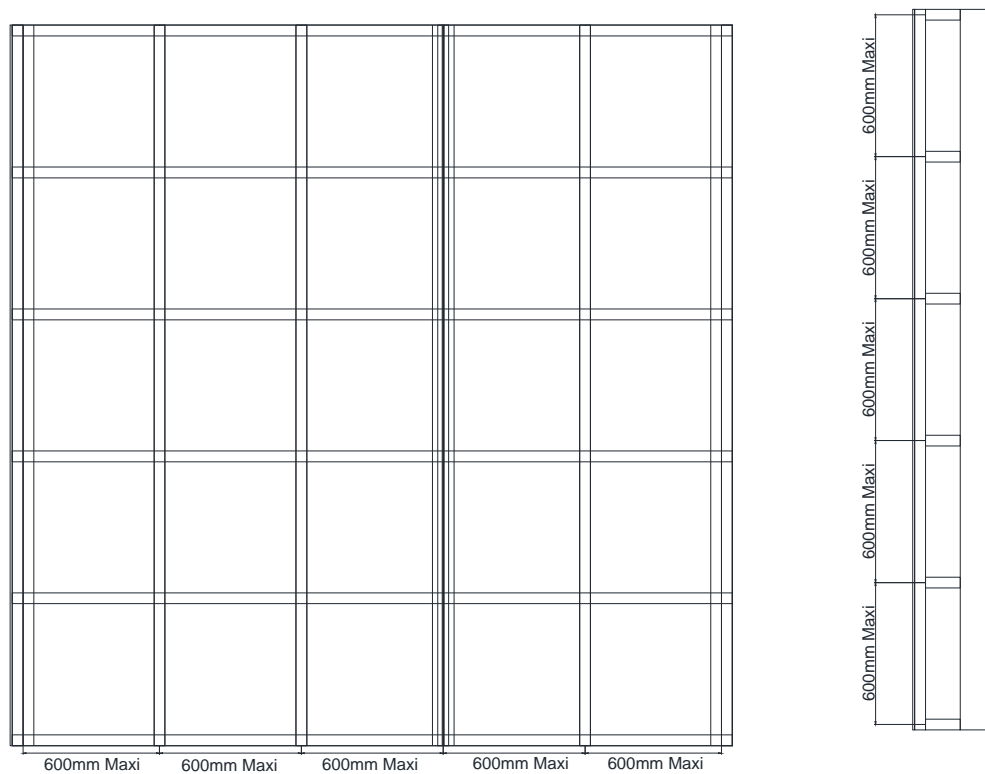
Pose en sous-face – Coupe verticale sans isolant
